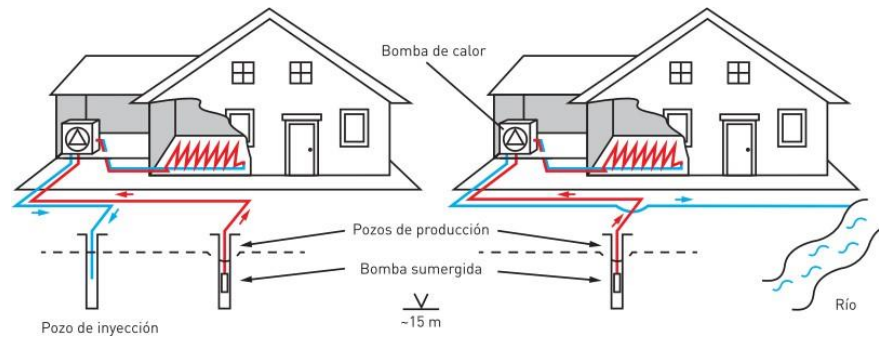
Esquema sistema de extracción abierto. Fuente [24]
